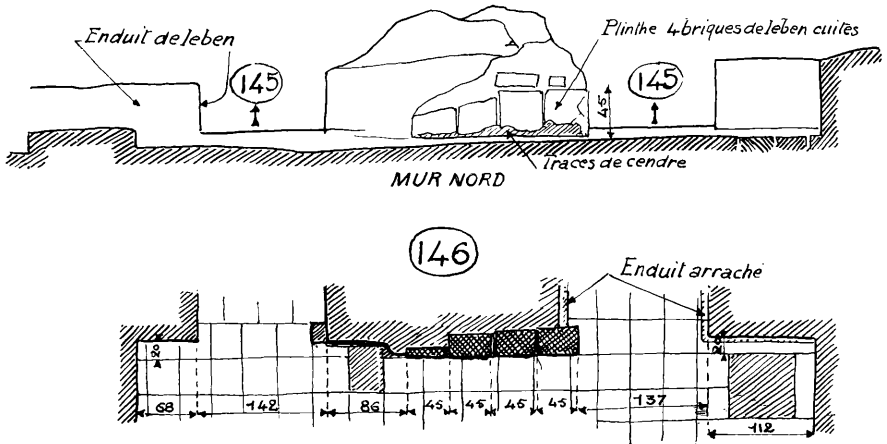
Cour 146. Élévation et plan du mur nord.
